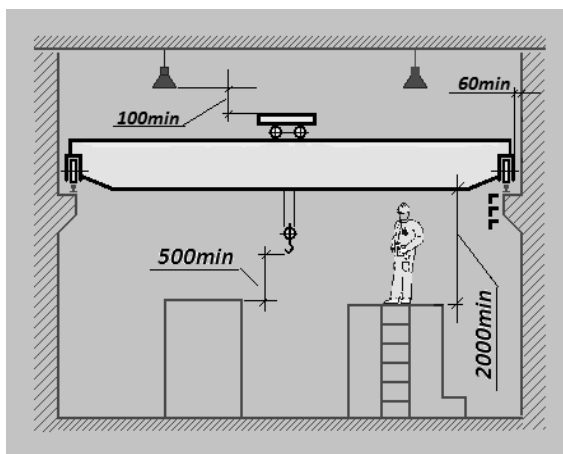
Расстояния до здания и оборудования при установке мостового крана
